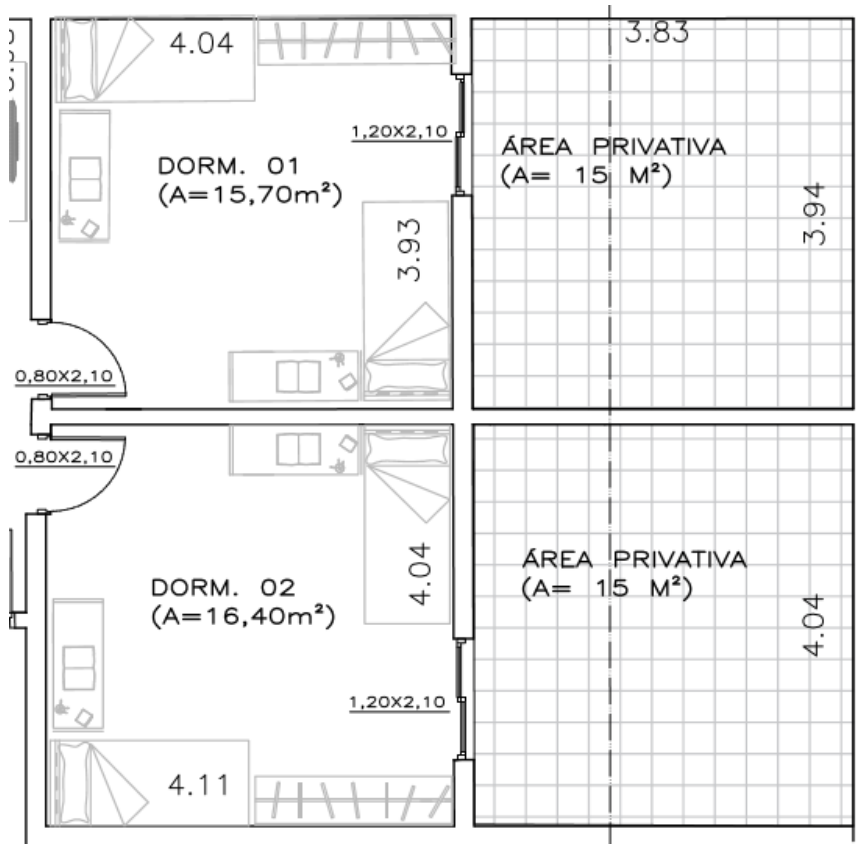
| Detalhe Planta de Estudos mais acessos- Fonte: Acervo do autor,
